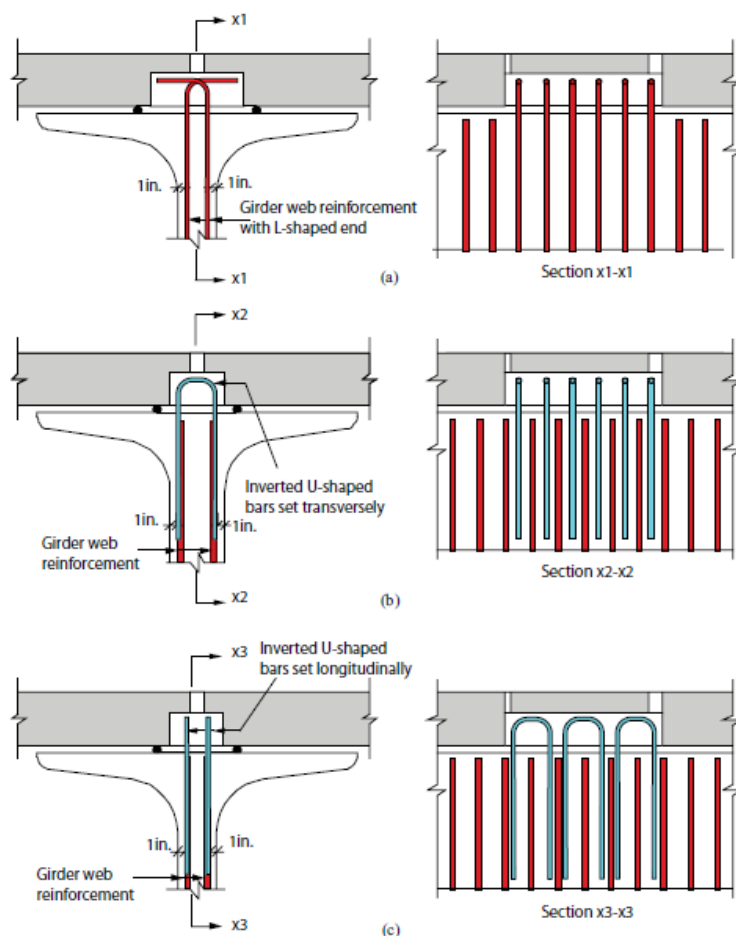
Connexion interne entre une dalle préfabriquée et une poutre en béton (Badie & Tadros, 2009)
